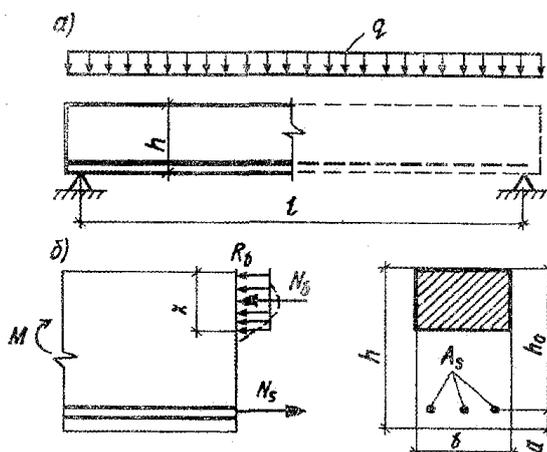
Расчётная схема изгибаемого элемента с одиночной арматурой
